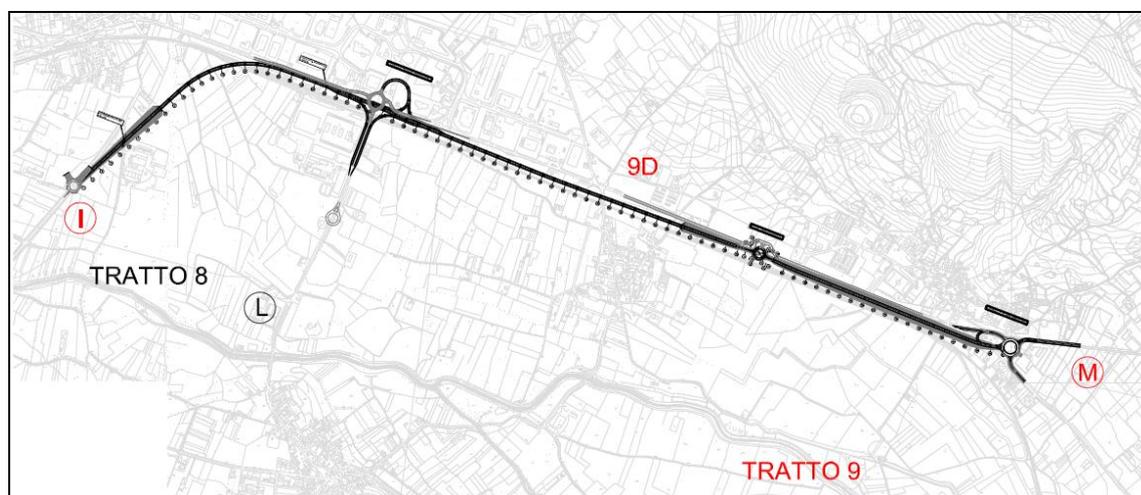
Planimetria LOTTO C con Alternativa di progetto 9D
